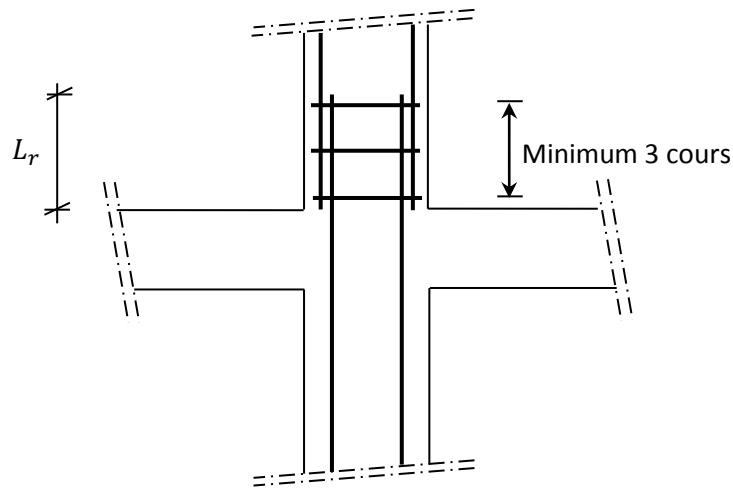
Les armatures transversales dans la zone de recouvrement
